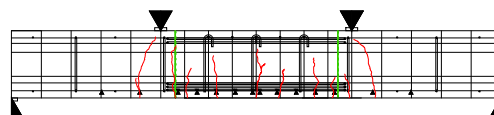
ひび割れ図 (P₃₀₀ 到達時)
